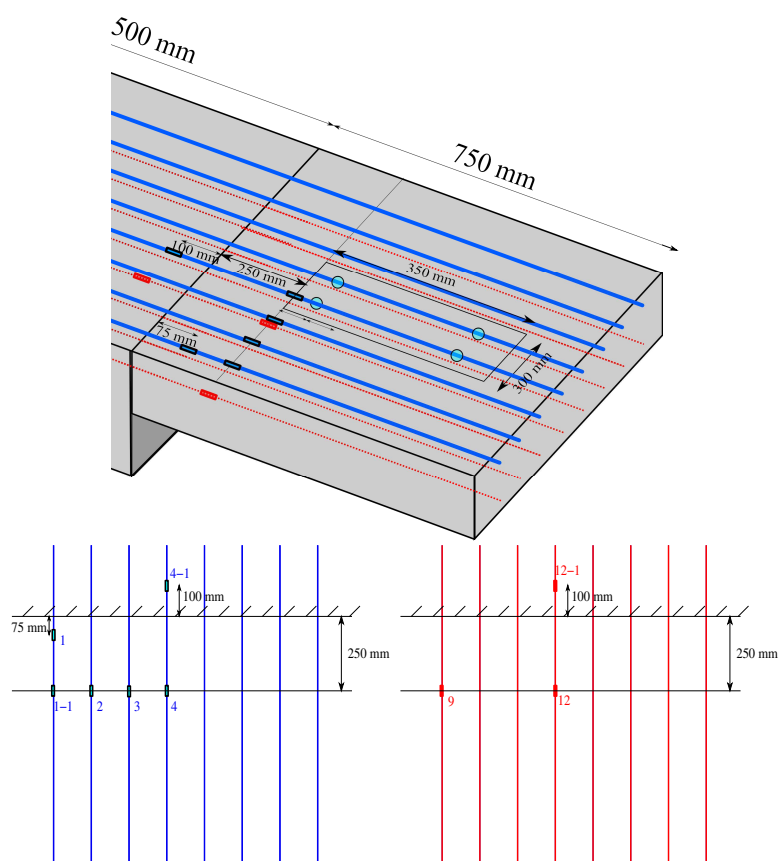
Position des jauges de déformation sur les armatures de la dalle 3
